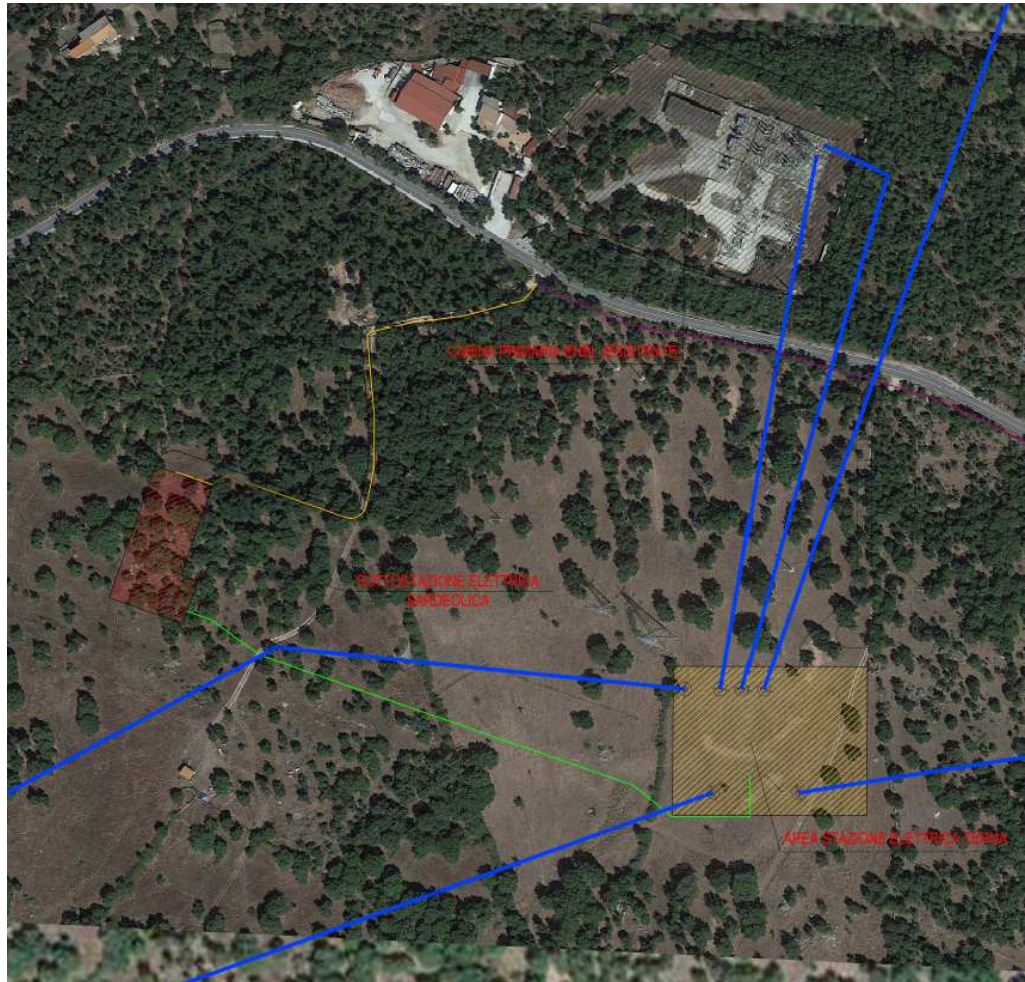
Sovrapposizione area stazioni elettriche con foto aerea
